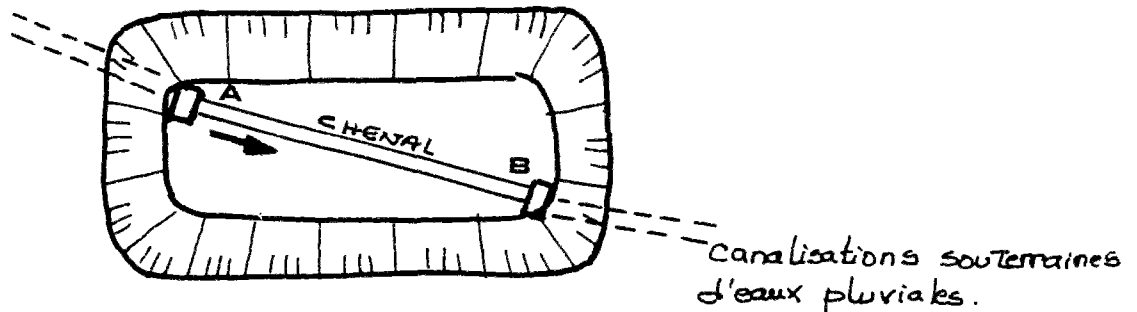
Schéma du bassin de la Fosse MAUSSOIN
